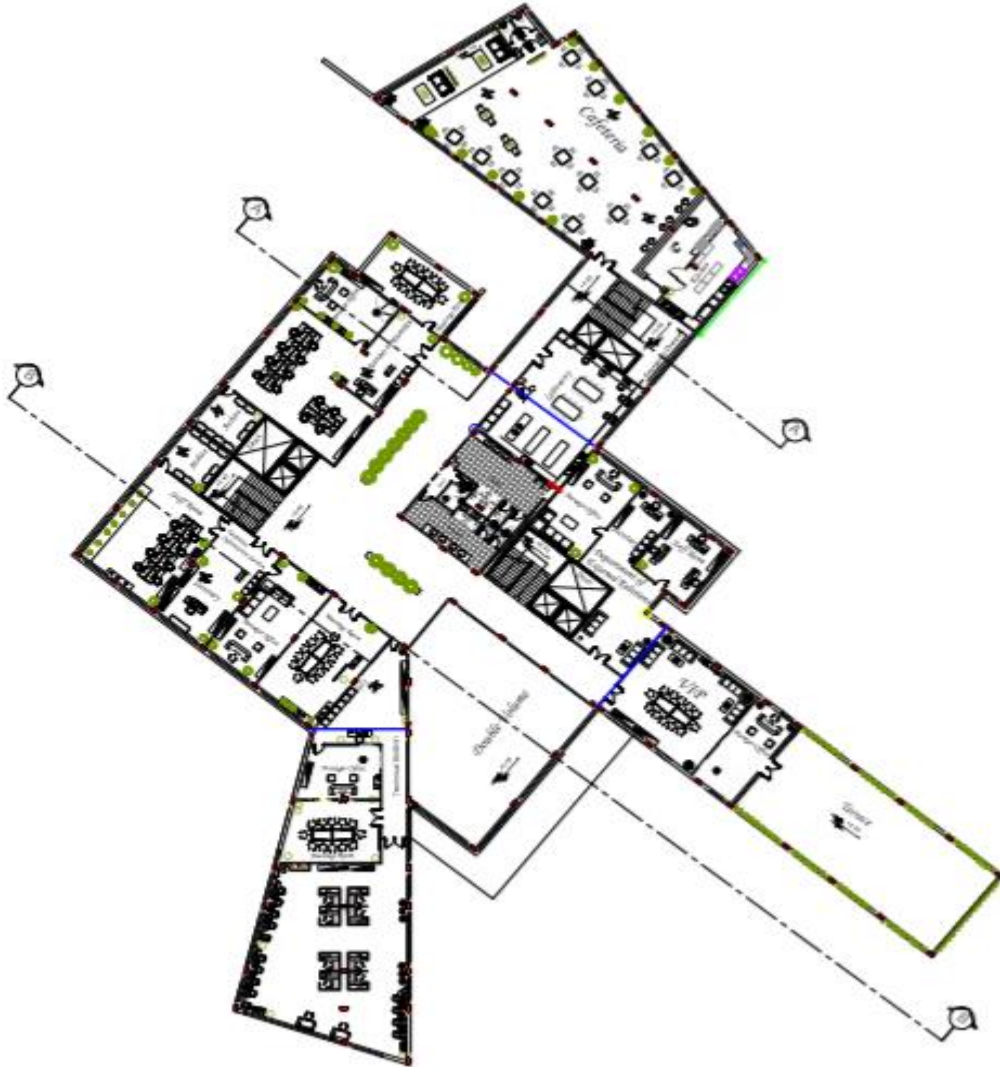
مسقط الأفقي للطابق الأرضي
